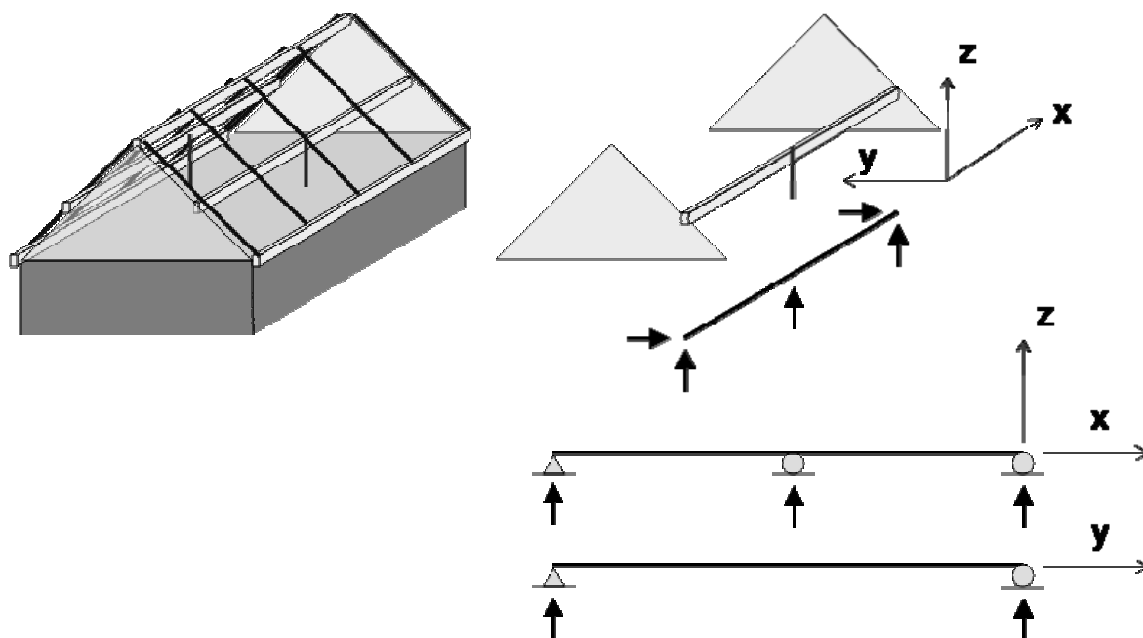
Arcareccio intermedio con appoggio intermedio su pilastro - sollecitazioni nel piano della sezione e sistemi statici
